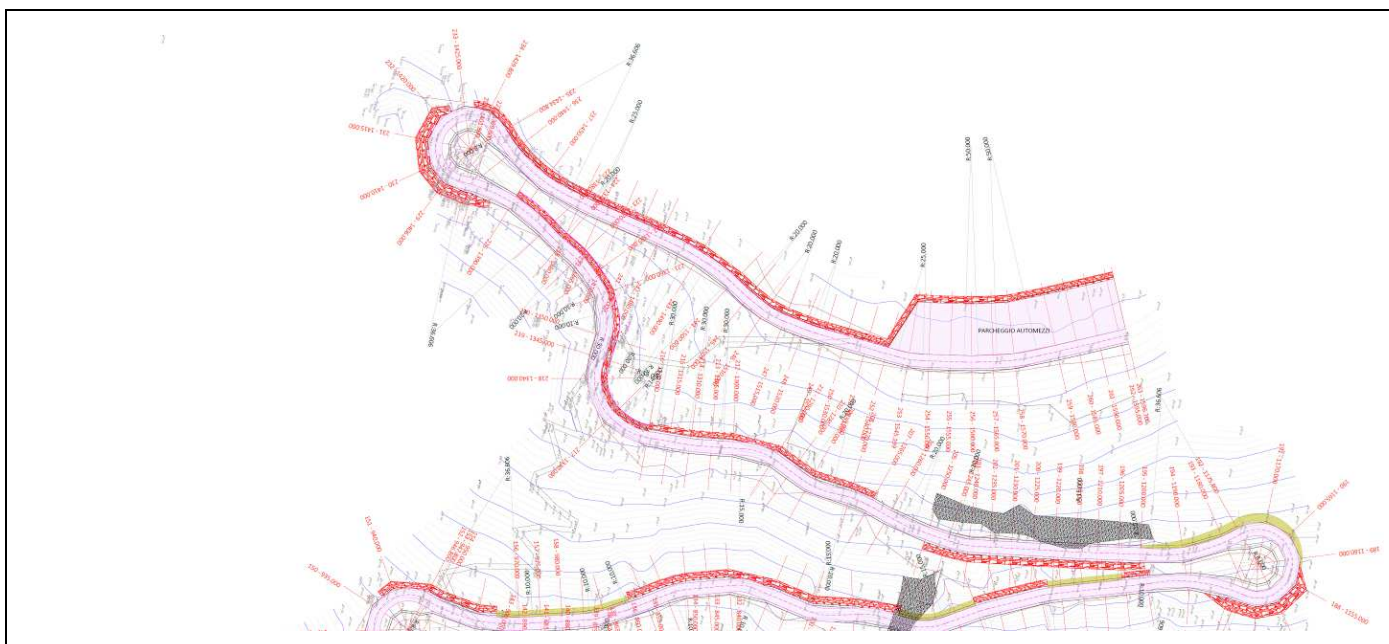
estratto planimetrico tratto a tornanti [tavola B3 Studio Maraffio]
